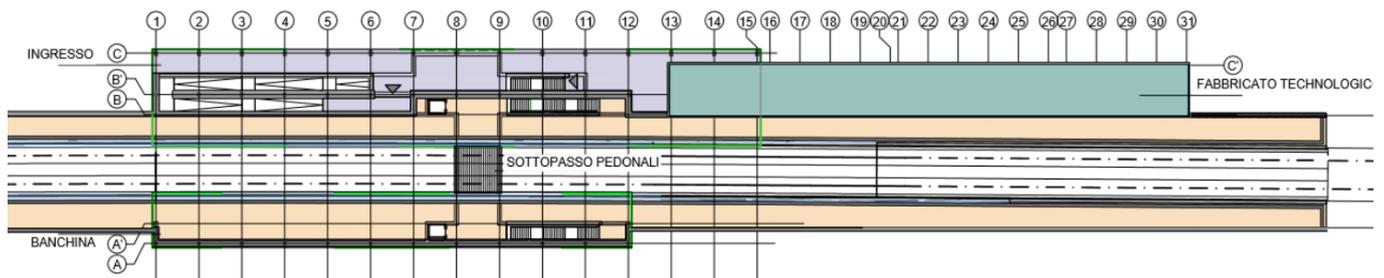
Planimetria generale della fermata con individuazione manufatti di nuova realizzazione
